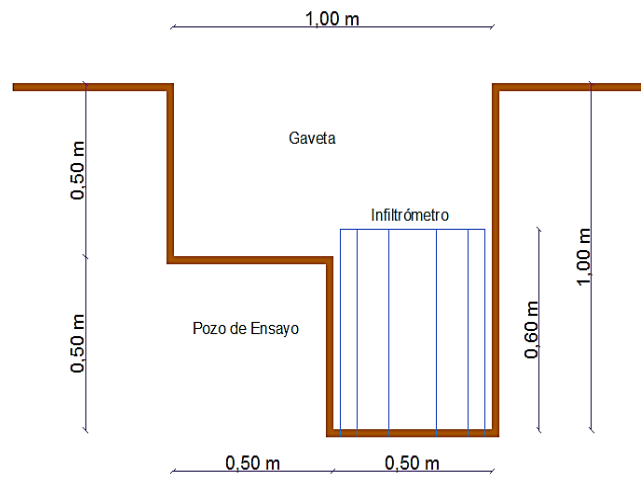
Corte de la gaveta, pozo de ensayo e infiltrómetro
